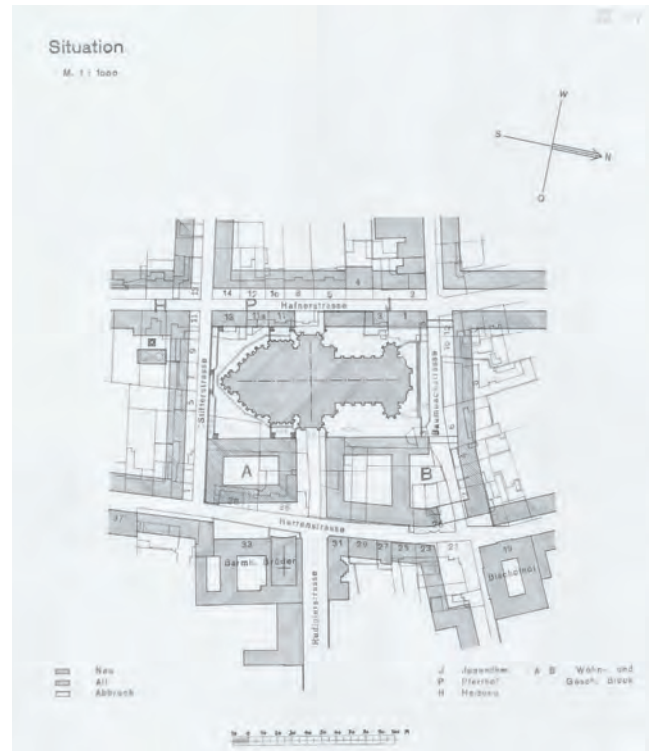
Lageplan zur Bebauungsstudie des Domviertels, Verfasser unbekannt, vermutlich 1980er Jahre
